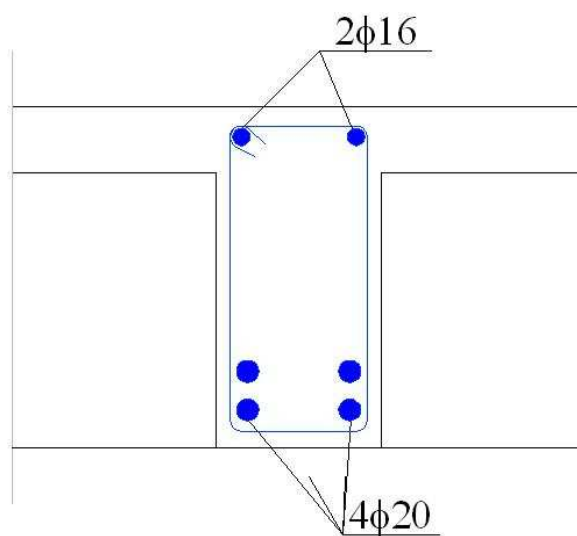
Corte da laje com armadura inferior das nervuras na direcção "y".
